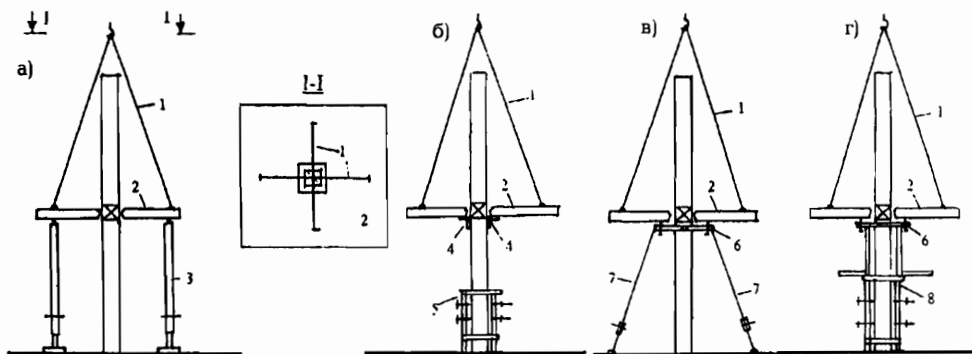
Монтаж надколонных плит: а – выверка плиты выдвижными стойками; б – плиты на «монтажных столиках» с закреплением колону в типовом кондукторе; в – выверка плит регулировочными винтами в закрепленном на колонне раме-кондукторе, с раскреплением колонны подкосами; г) – выверка плит специальным кондуктором с регулировочными винтами и корректировкой вертикальности колонны; 1 – четырех-ветвевой строп; 2 – надколонная плита; 3 – телескопическая монтажная стойка; 4 – монтажный столик; 5 – одиночный кондуктор типовой конструкции; 6 – рама-кондуктор с регулировочными винтами; 7 – подкос для крепления колонны; 8 – кондуктор специальной конструкции с регулировочными винтами и площадками
